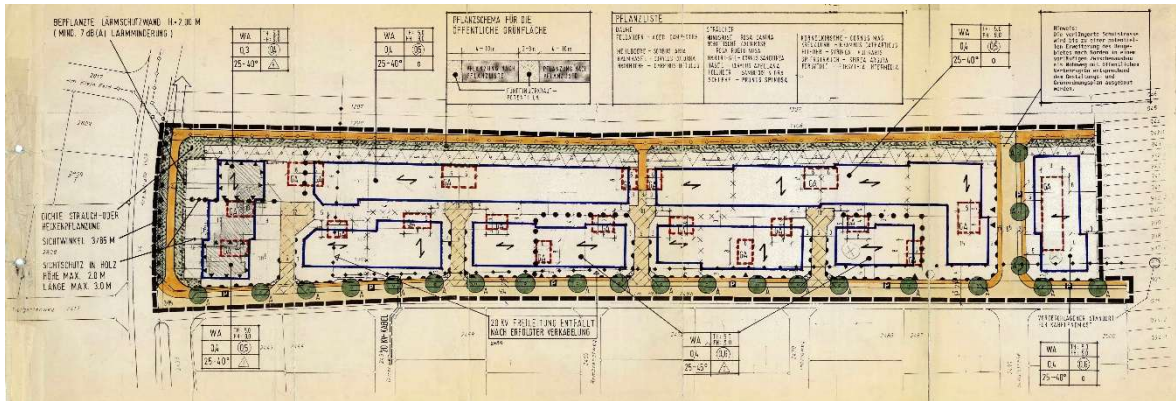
Bebauungsplan „Pfad - Erweiterung“, Urfassung 1989
